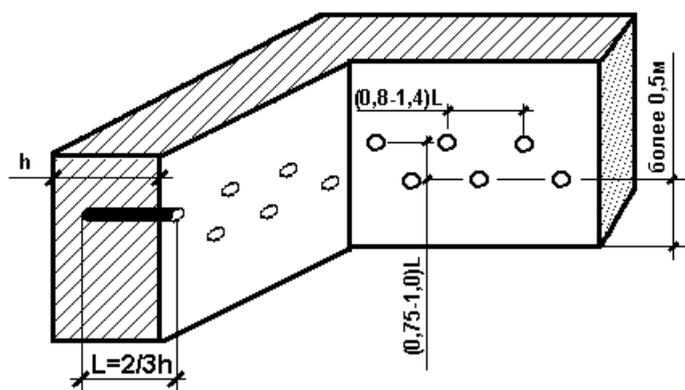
Схема расположения шпуров в стене при обрушении здания на основание.
